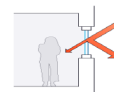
Acristalamiento de fachada sur. Elaboración propia.
